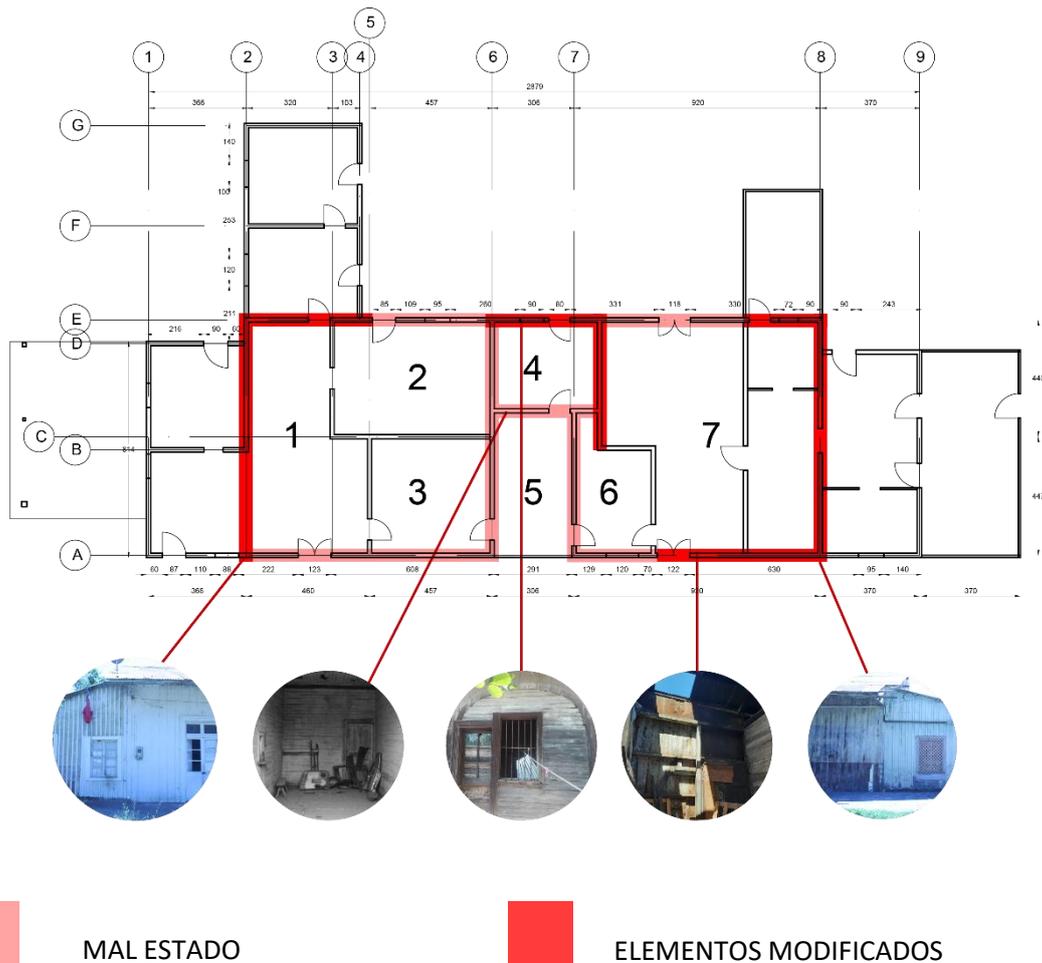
Esquema daños, Muros. Fuente: Elaboración Propia.
